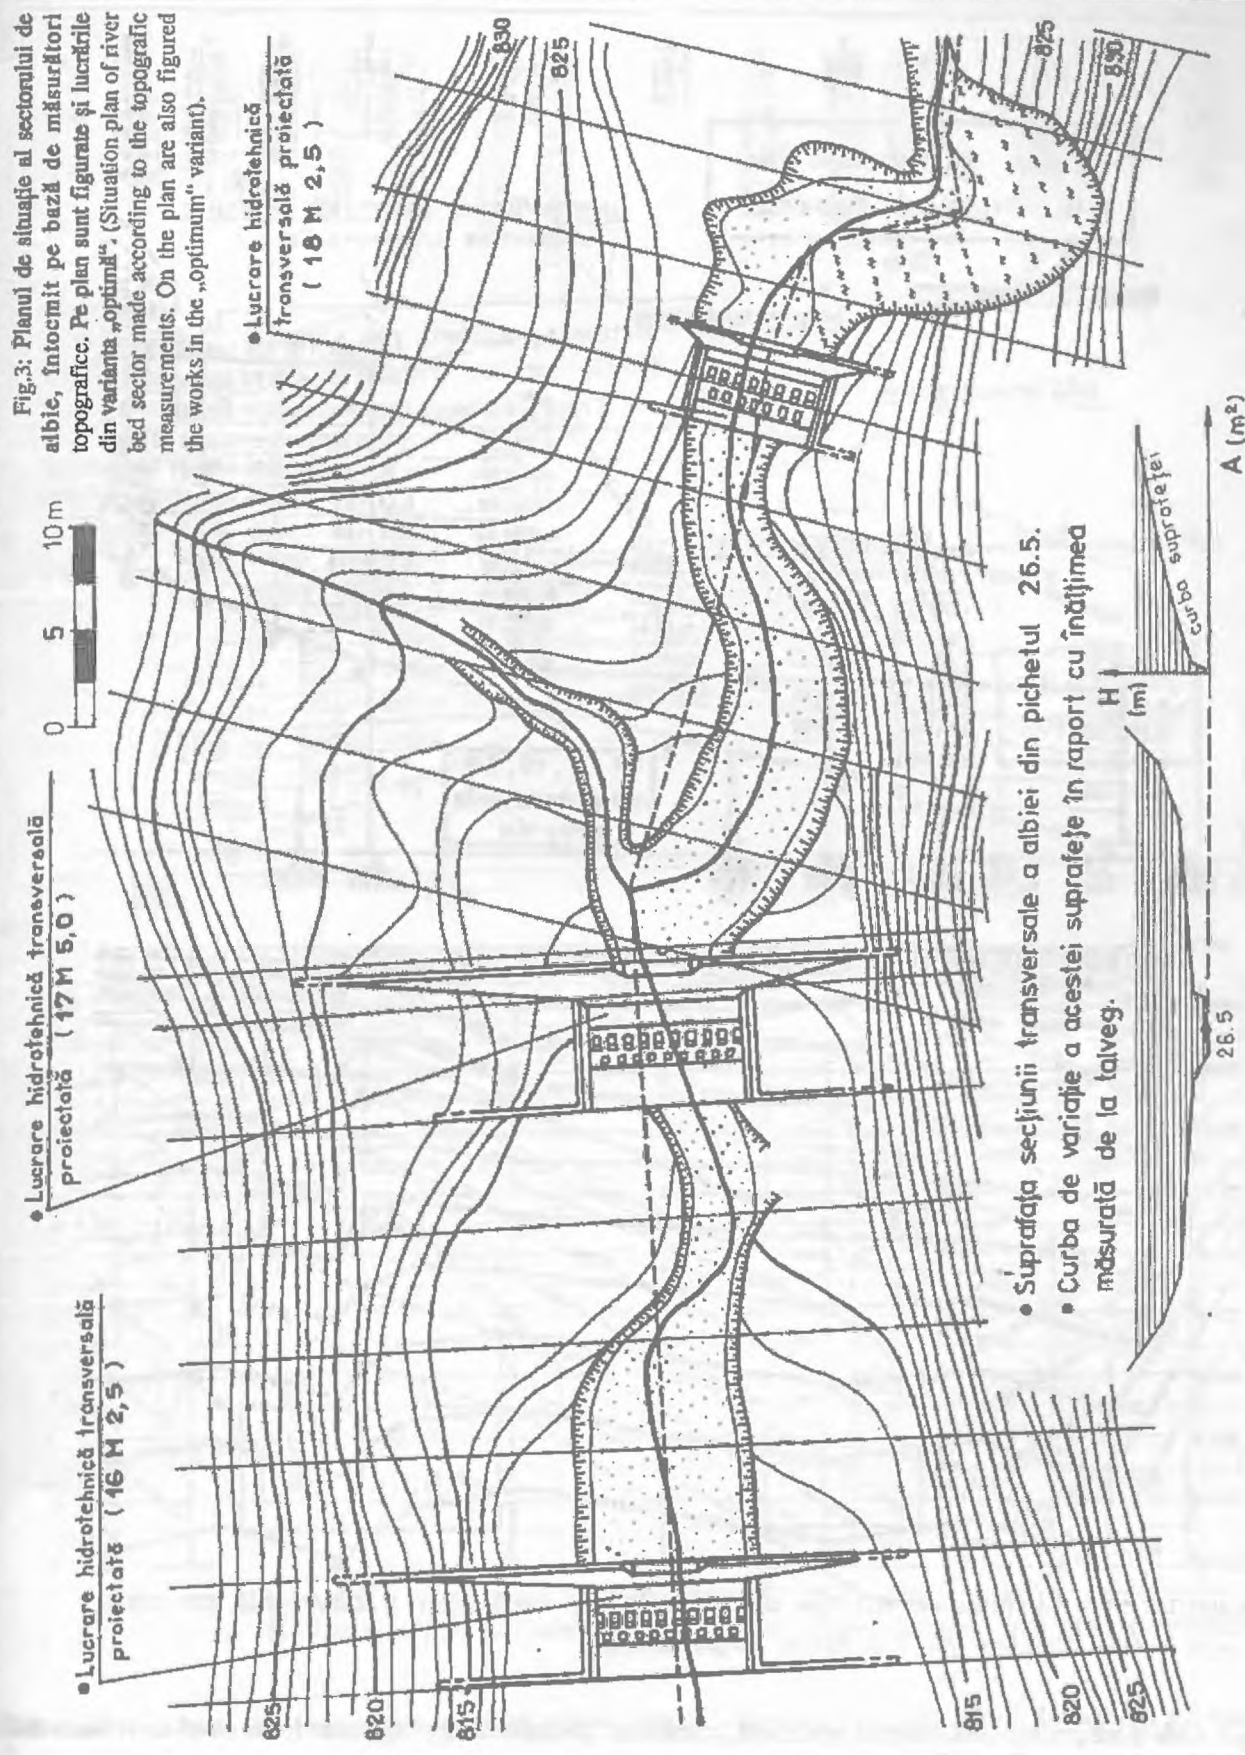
Planul de situație al sectorului de albie, întocmit pe bază de măsurători topografice. Pe plan sunt figurate și lucrările din varianta „optimă”. (Situation plan of river bed sector made according to the topographic measurements. On the plan are also figured the works in the „optimum” variant).
